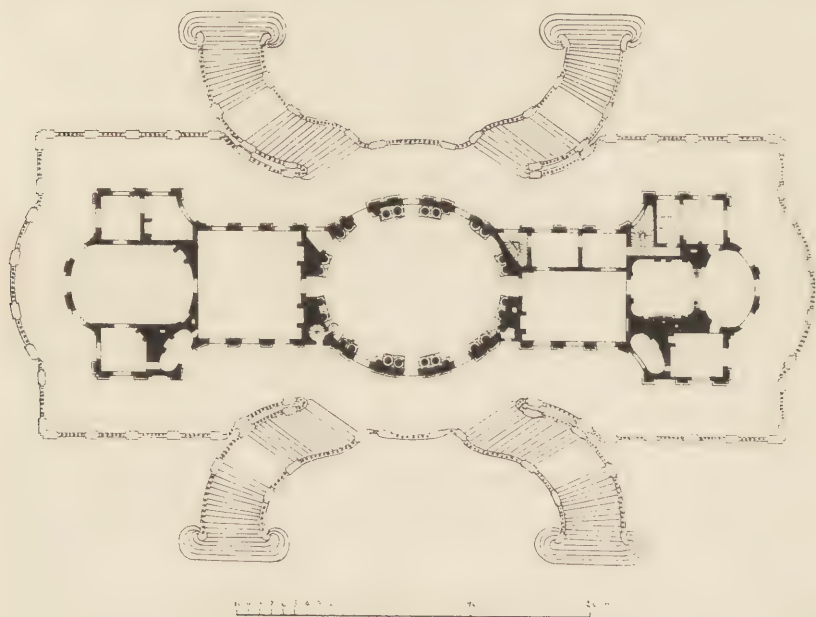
Schloss Solitude bei Stuttgart. Grundriss.
